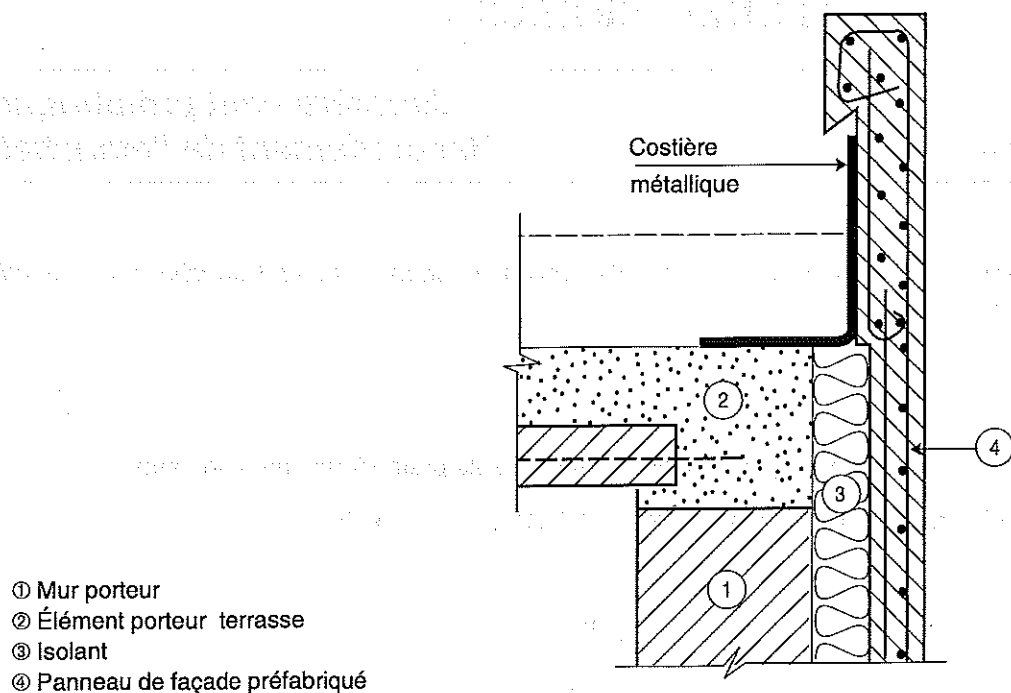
Acrotère préfabriqué faisant partie d'un panneau de façade préfabriqué.
